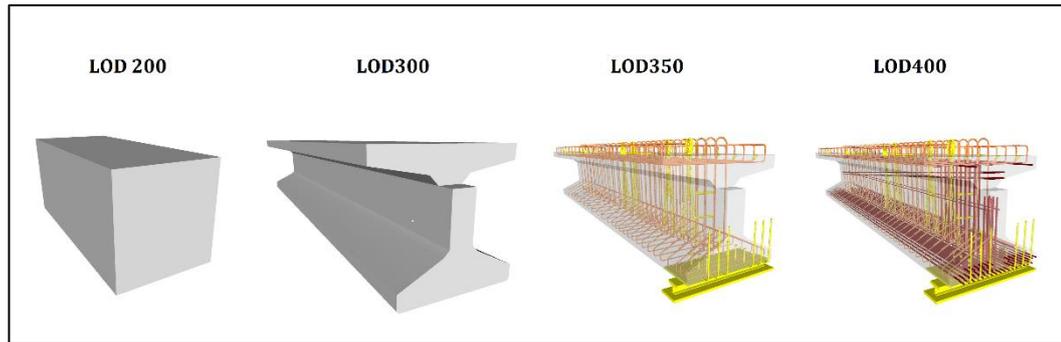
LOD 200 al 400 viga prefabricada.
